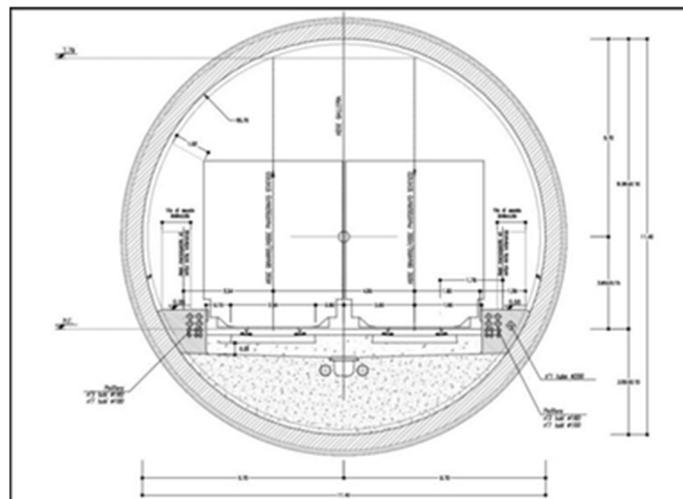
Sezione di intradosso gallerie di linea per scavo meccanizzato (sezione corrente)
